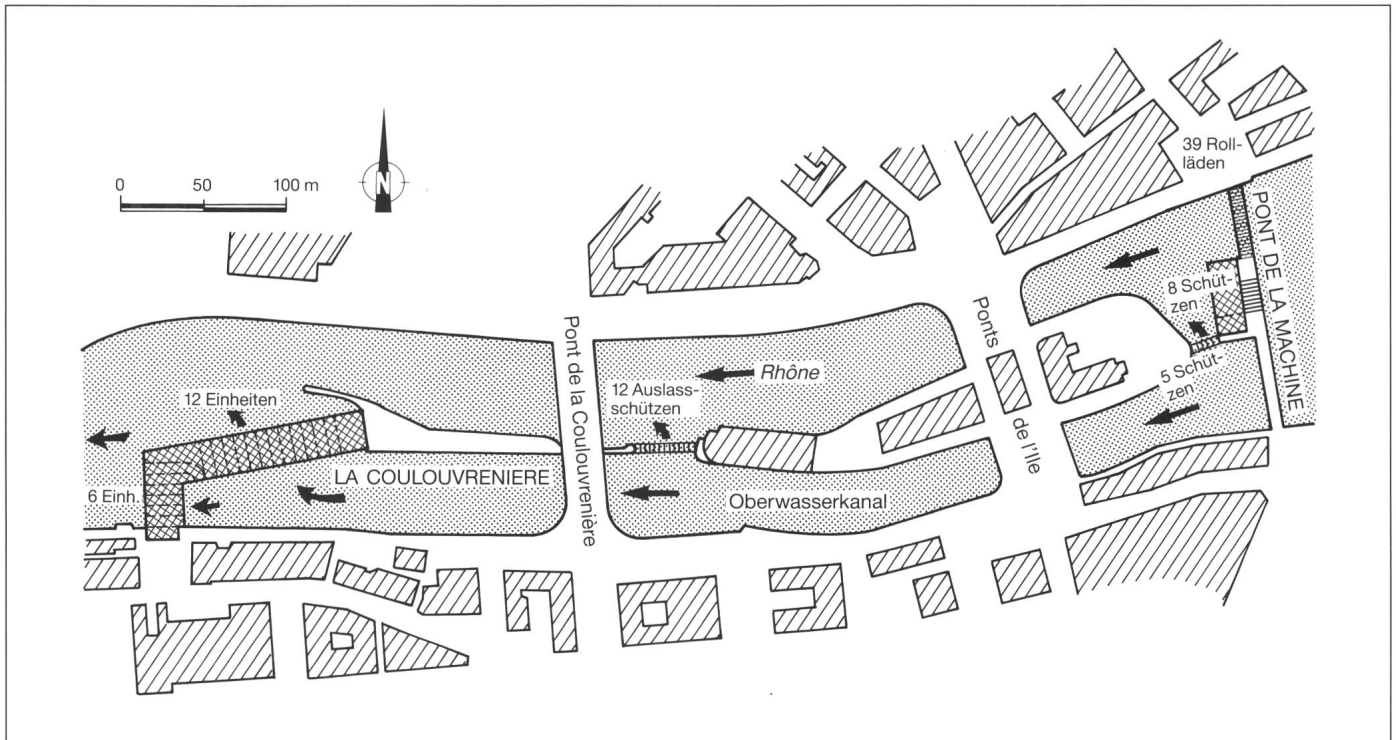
Plan des Wasserwerkes La Coulouvrenière in Genf
